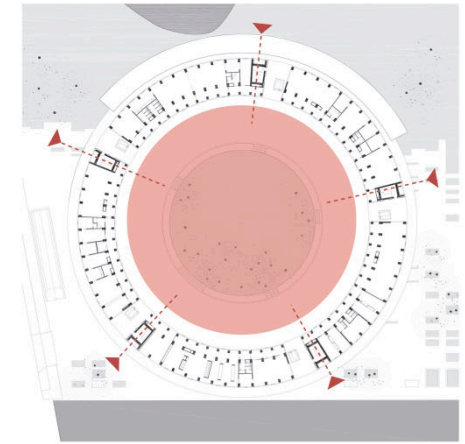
Apertura a la ciudad, planta baja de usos públicos.
